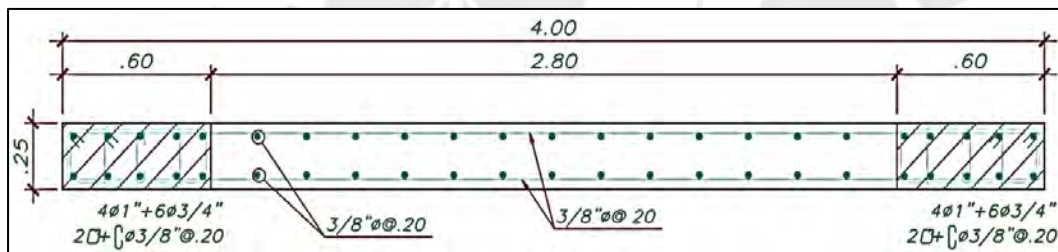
Esquema de armado final del refuerzo para el primer piso: placa P-2
